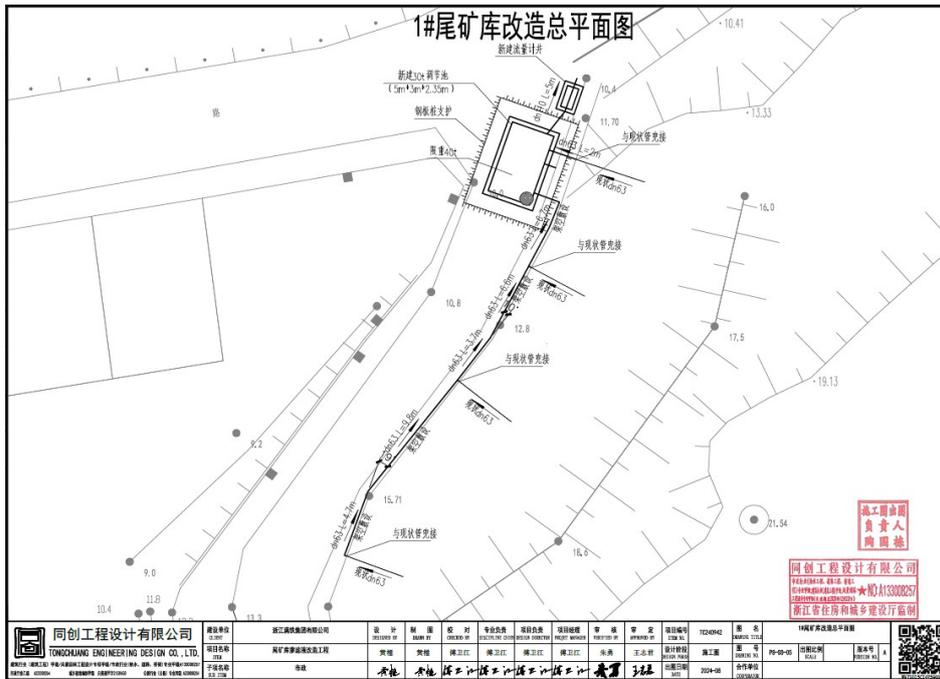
1#尾矿库渗滤液收集系统改造总平面图
